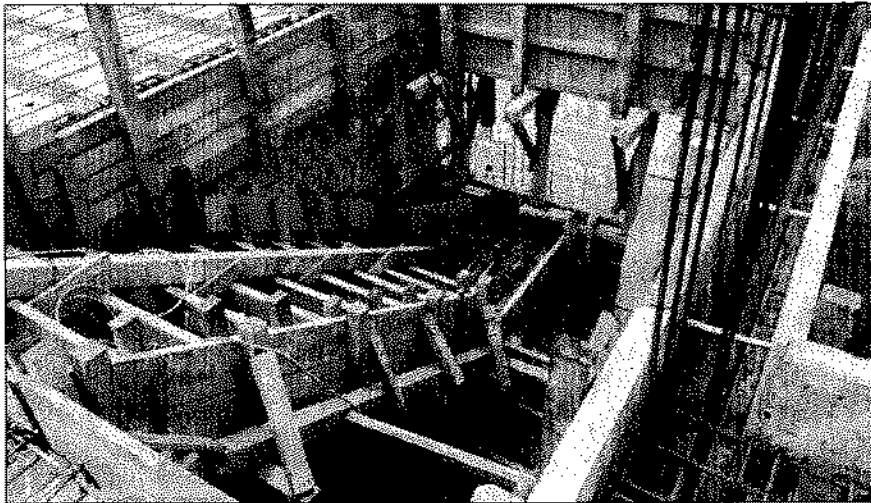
Colocado de encofrado y refuerzo de escalera.
